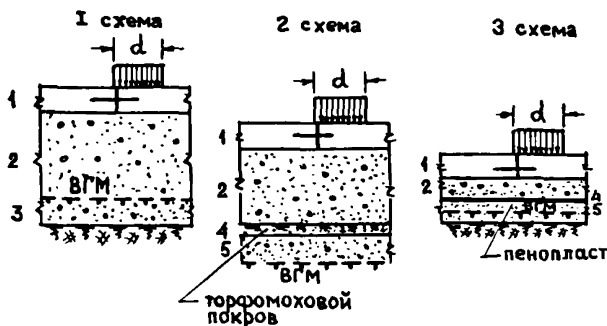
Схемы для расчета жестких покрытий: 1 - бетонное покрытие; 2 - материал насыпи в талом состоянии; 3 - то же в мерзлом; 4 - слой теплоизоляции; 5 - грунт основания насыпи в талом состоянии
